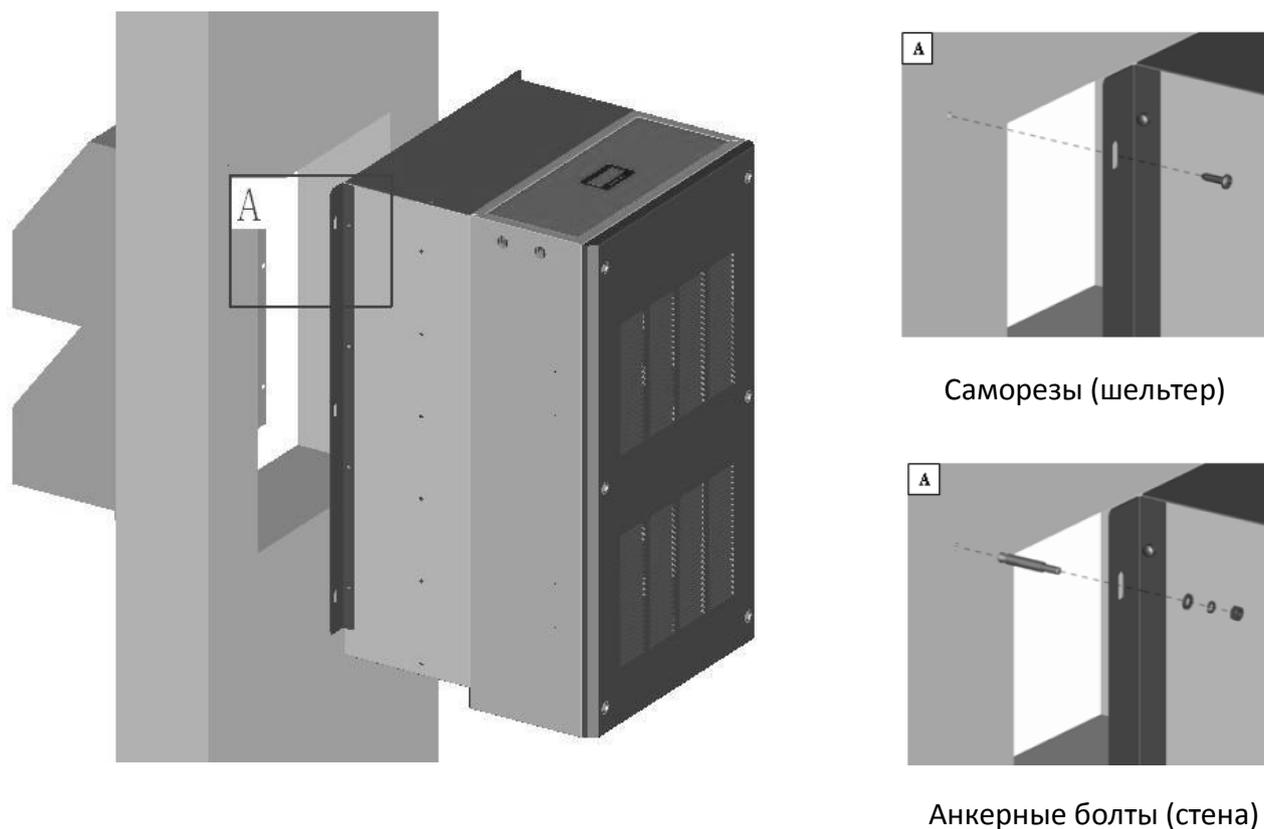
Установка и сборка агрегата и воздухозаборного колпака
